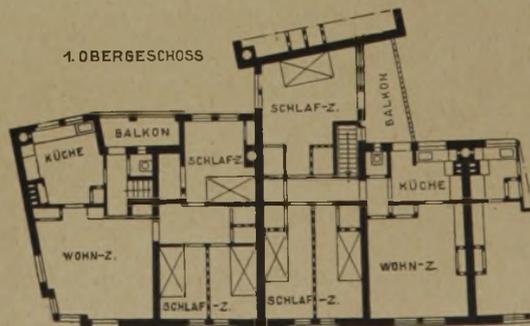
14 (unten). Grundrißaufteilung der Westecke.
